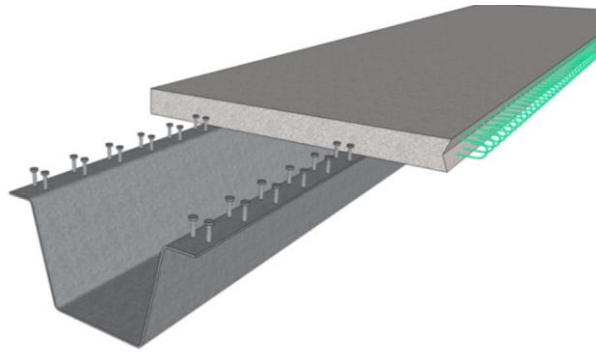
Puente modular conformado por viga de acero plegada en frío y losa de hormigón armado.
